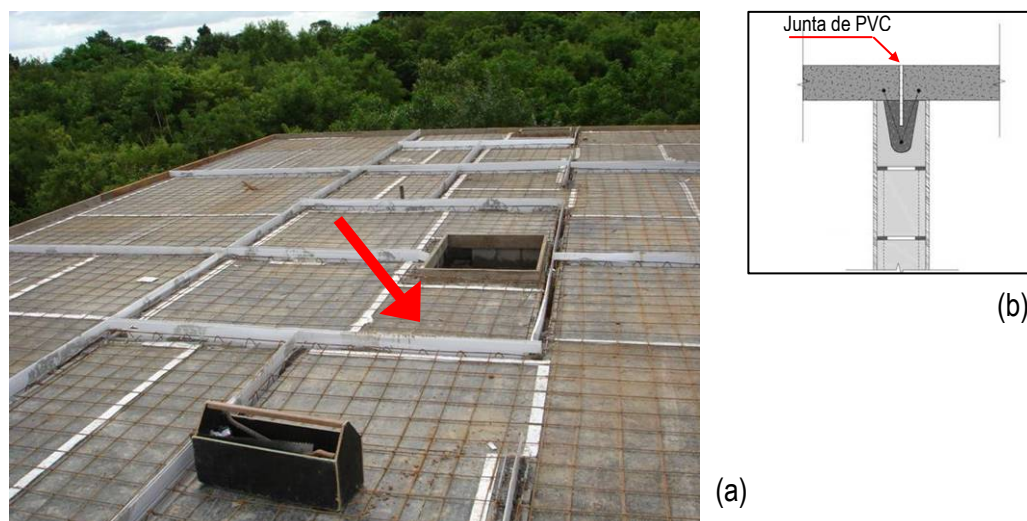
(a) juntas de retração sobre as paredes do último pavimento dos sobrados e (b) desenho da junta em detalhe
